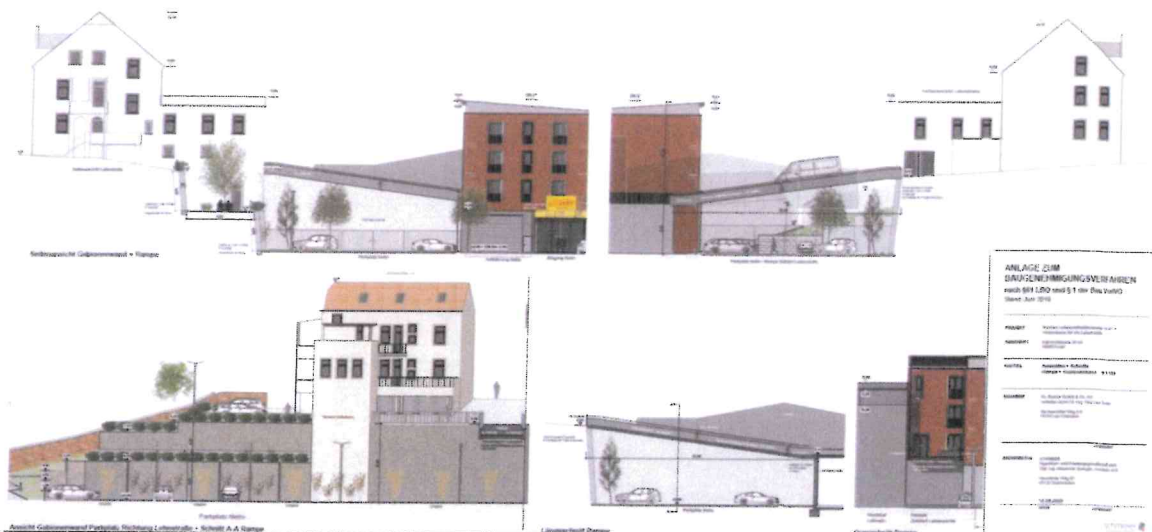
Nachtrag zum Baugenehmigungsverfahren (17.08.2020) – Ansichten und Schnitte der Rampe und Gabionenwand
